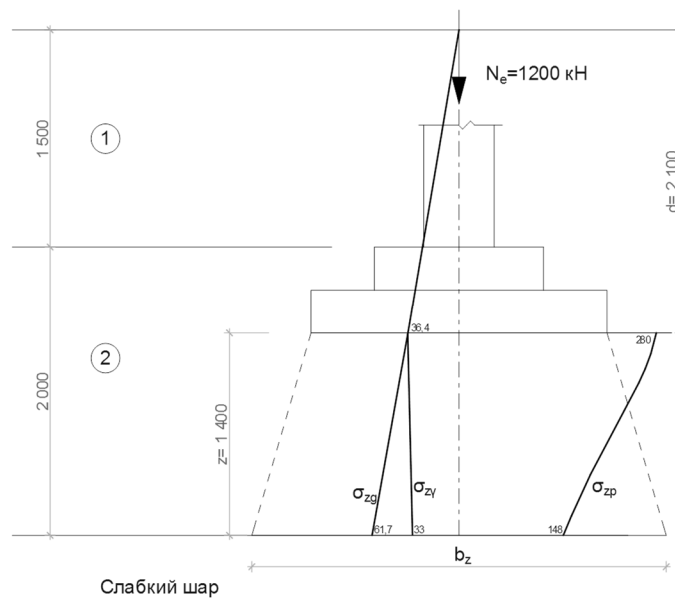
Епюри вертикальних напружень у ґрунті
